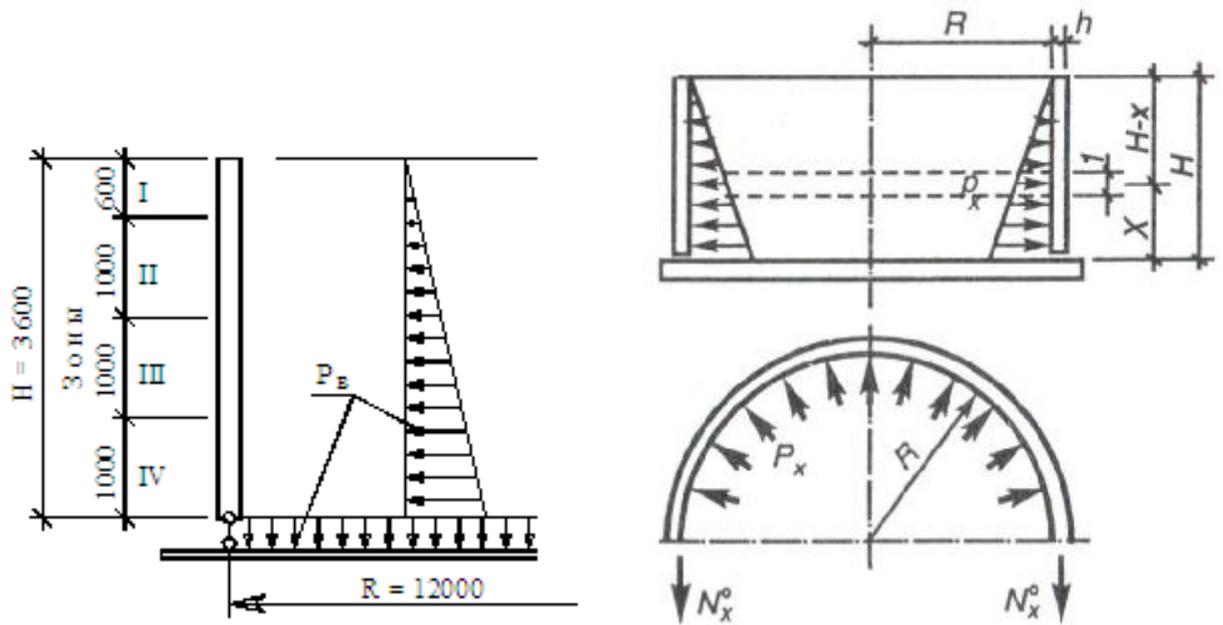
Разбиение стенки на зоны (а); расчетная схема резервуара (б).
